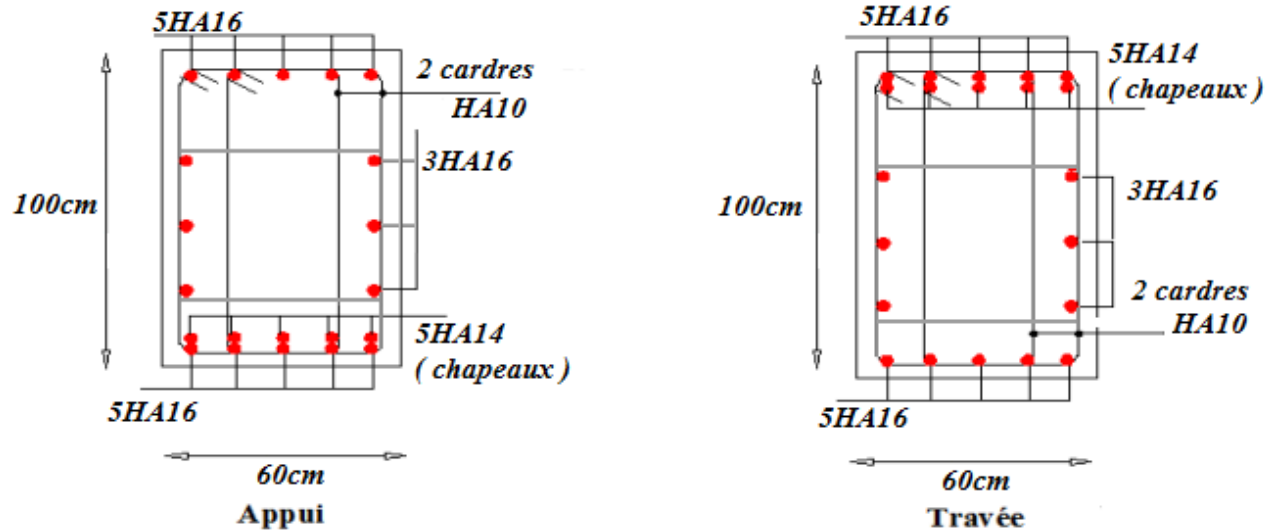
Schéma ferrailage de la nervure selon x-x
